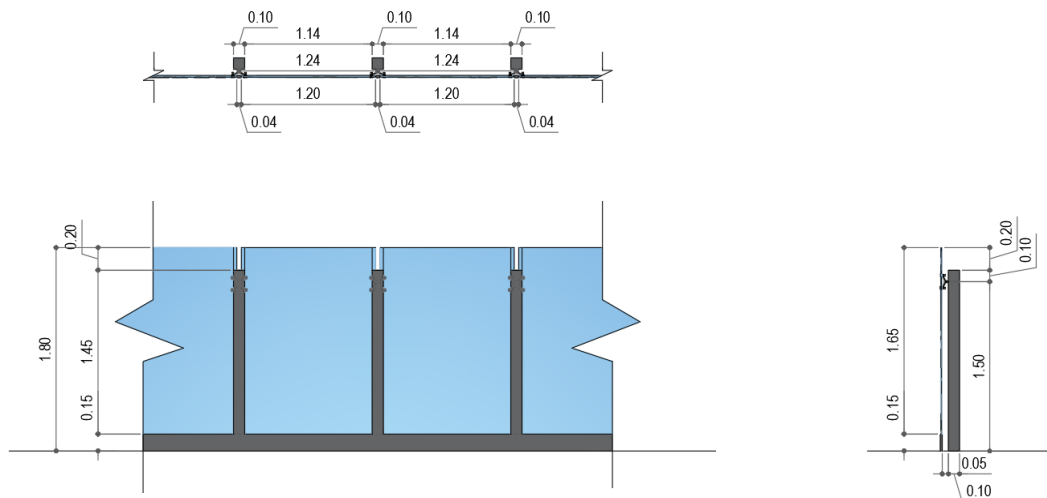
Detalle de barandales superiores Hotel Courtyard
